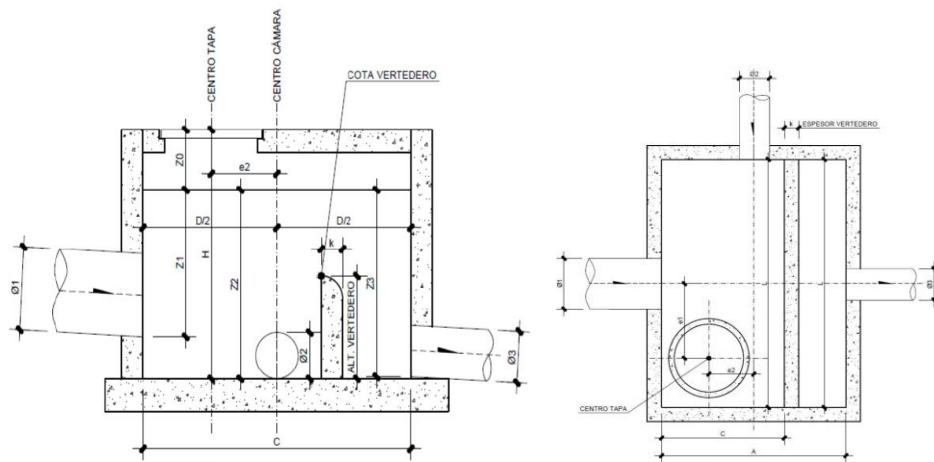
Vista en altura y planta de levantamiento de un aliviadero transversal.
